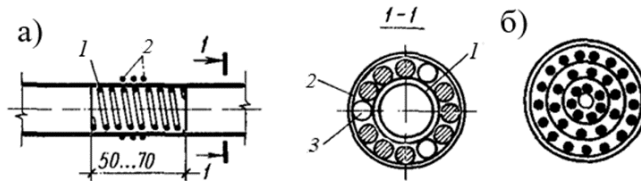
Арматурные пучки: 1 – спираль; 2 – скрутка; 3 – коротыш
